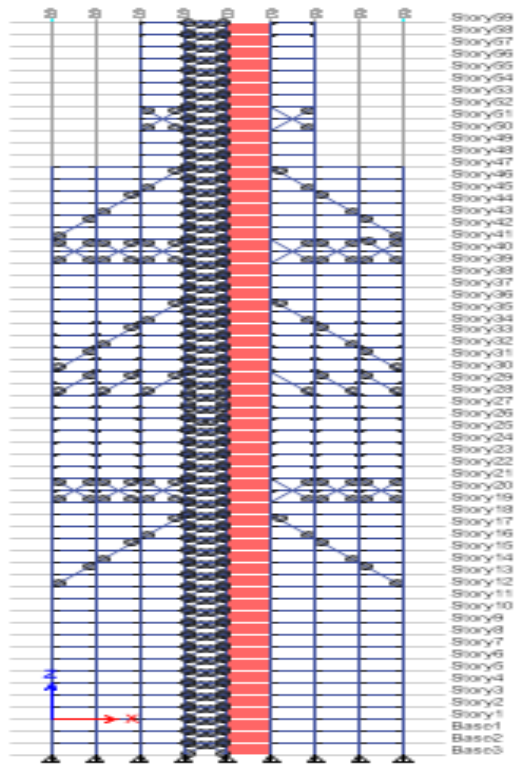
ΔΙΑΤΟΜΗ OUTRIGGER AND BELT TRUSS ZONE
